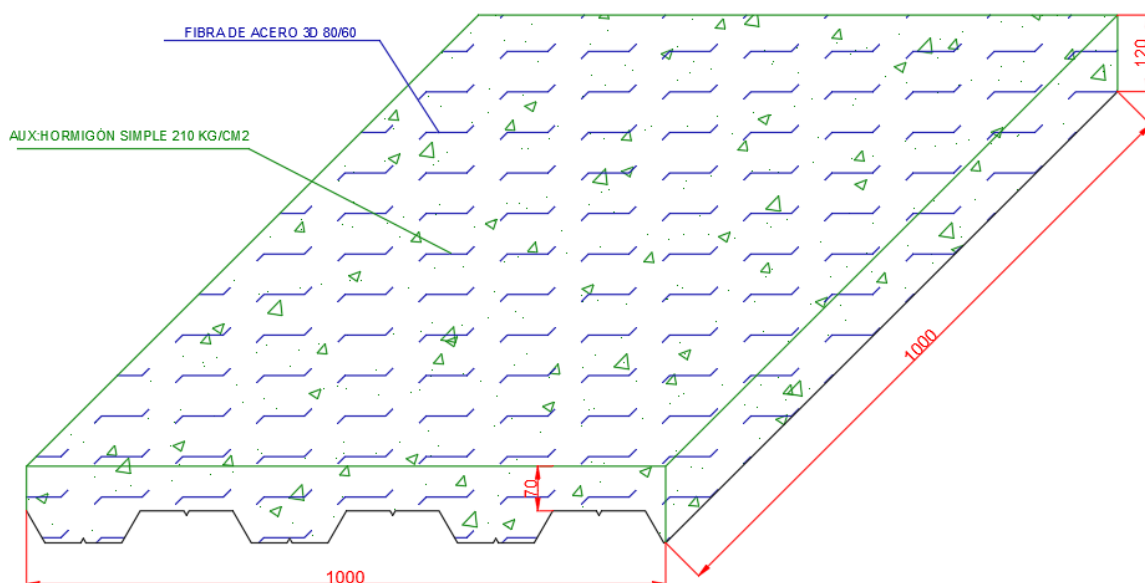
Rubro "Hormigón 210 con 15 fibra 80/60 en losa deck 7cm"
